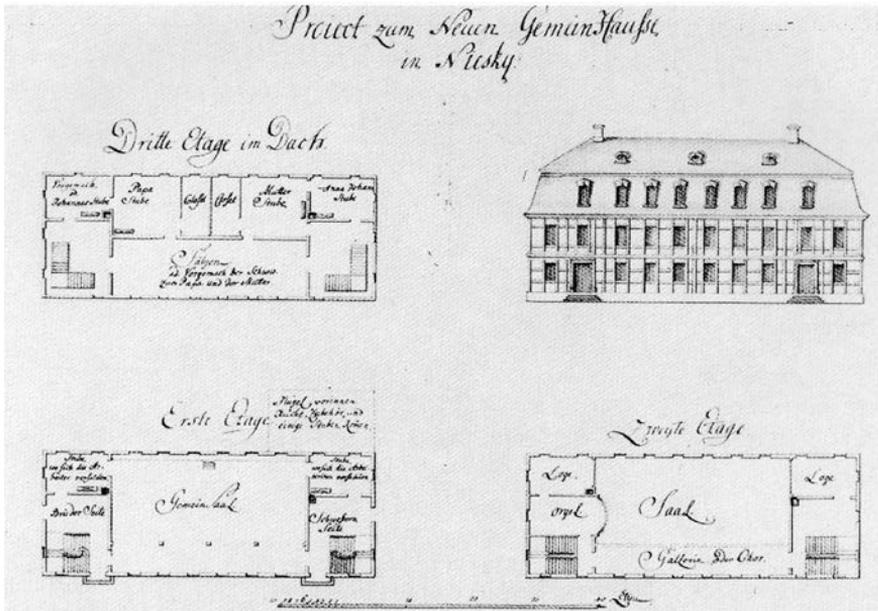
Projekt zum neuen Gemeinshause in Niesky, Entwurf zum Bau eines Gemeinshauses mit Kirchensaal in Niesky, Grundriss Erdgeschoss, erste und zweite Etage, Ansicht der Fassade, nicht ausgeführt, [1756], (UA, TS Bd. 3.8)
